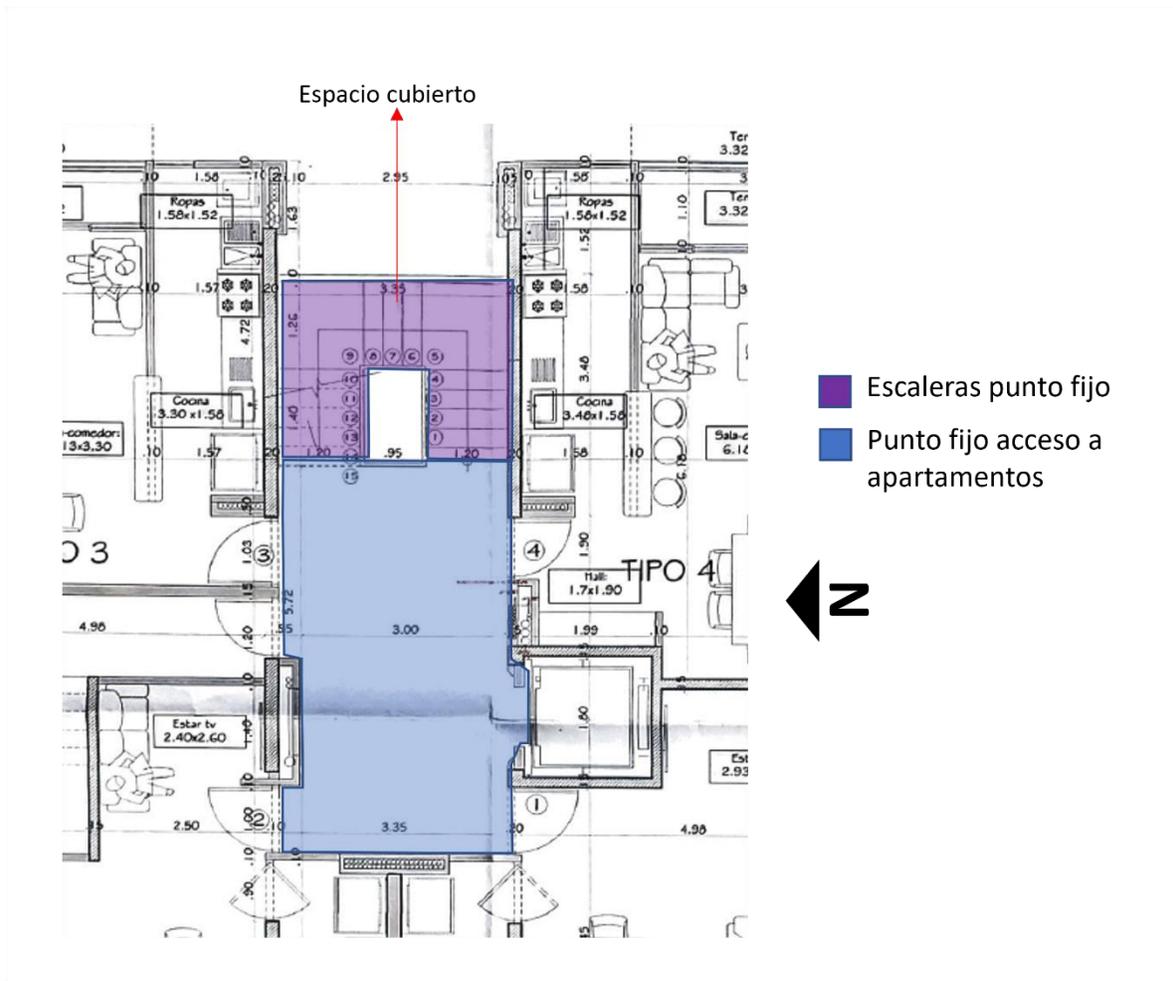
Detalle puntos fijos plano arquitectónico. Escalera – pasillo - acceso a los apartamentos
